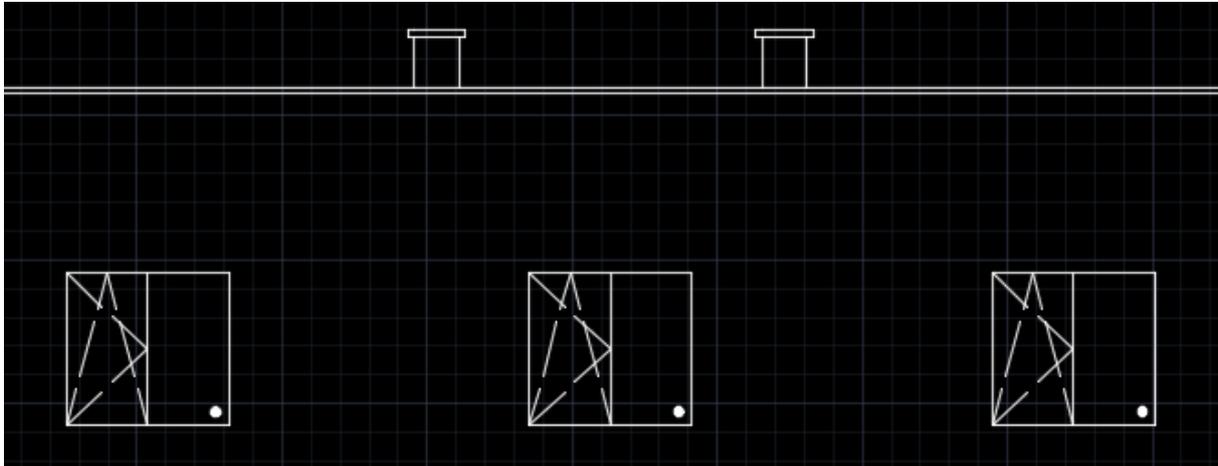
Изображение вентиляционных труб и окон на фасаде
